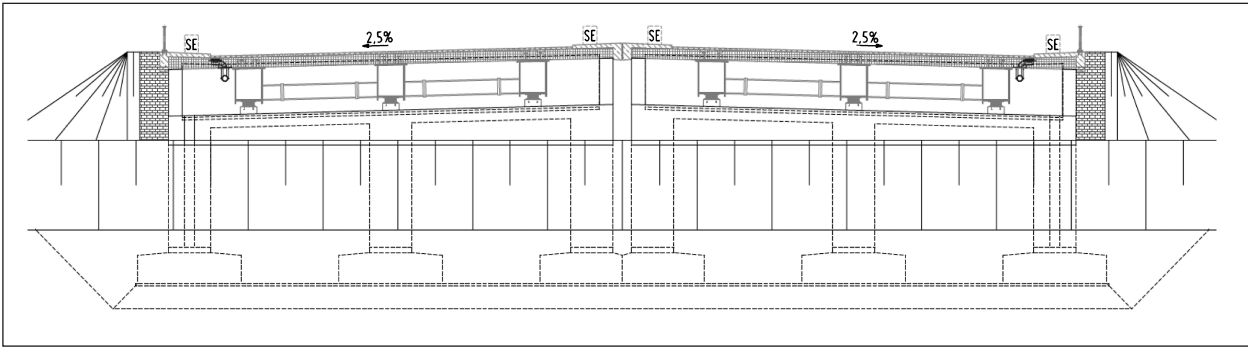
Stahlbetonhohlquerschnitt, aufgeständertes Widerlager
